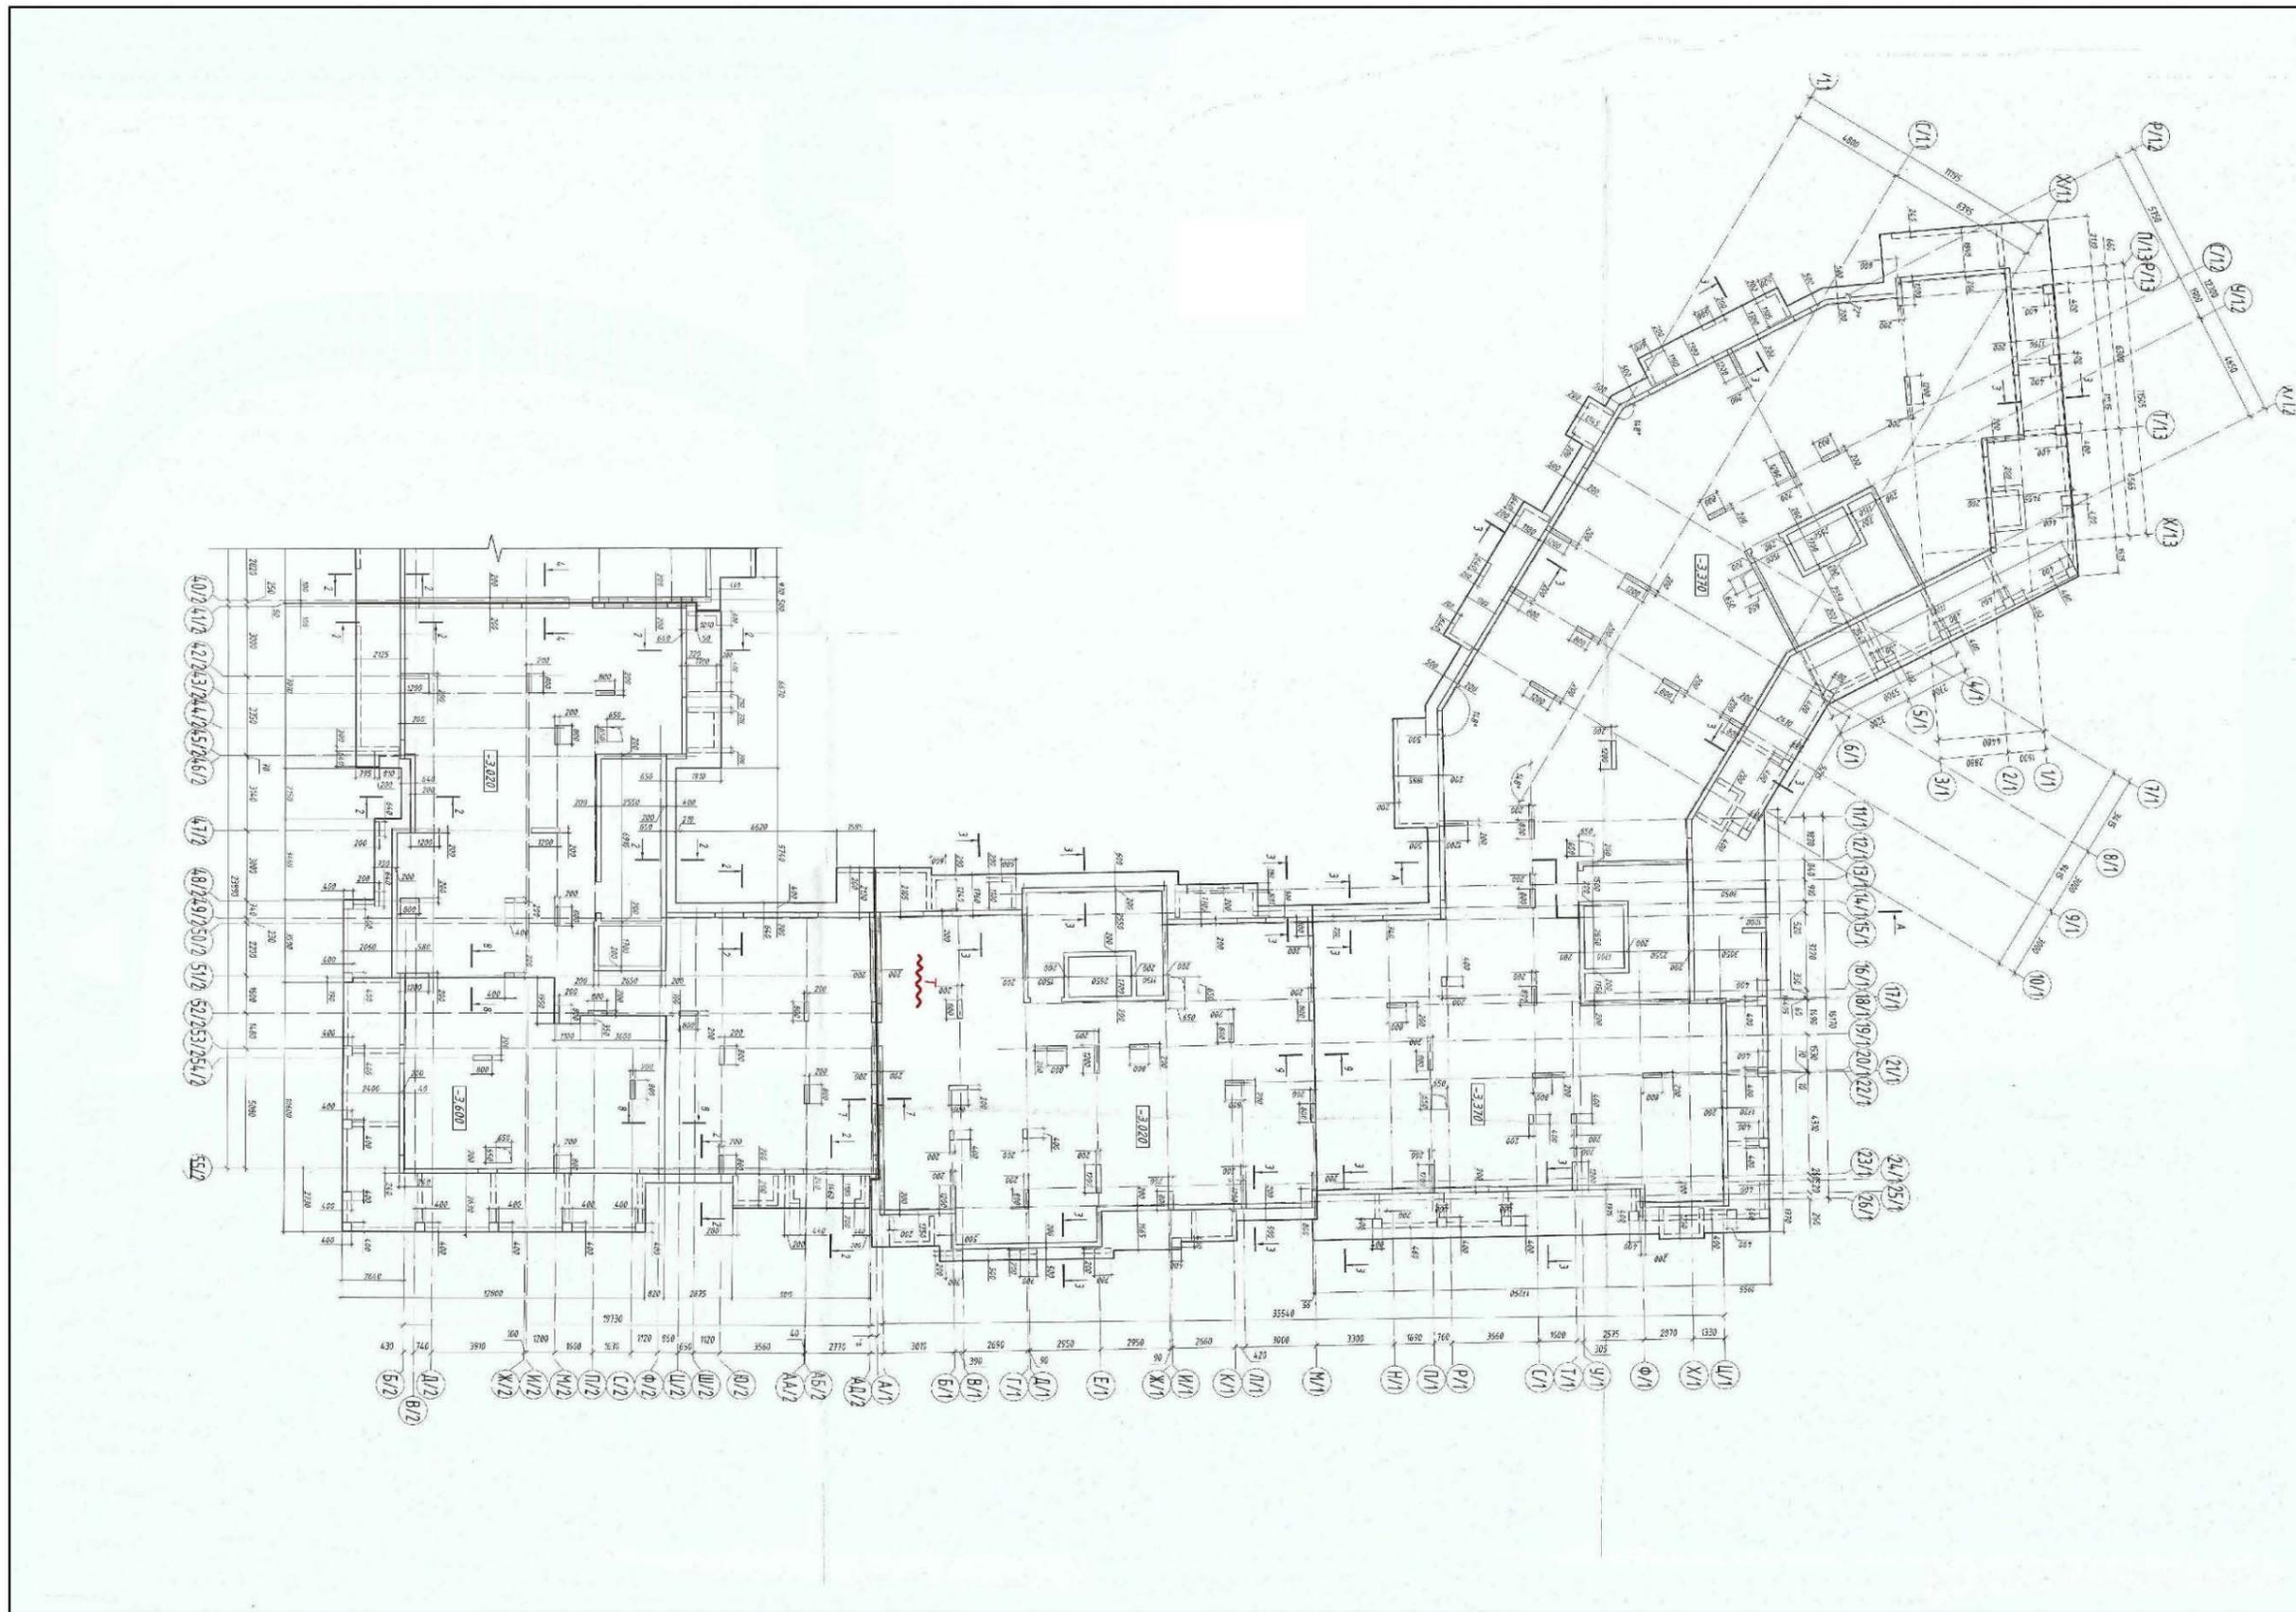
Карта дефектов нижней плоскости плиты перекрытия 1-го этажа (Секции 8,9,10,11)
